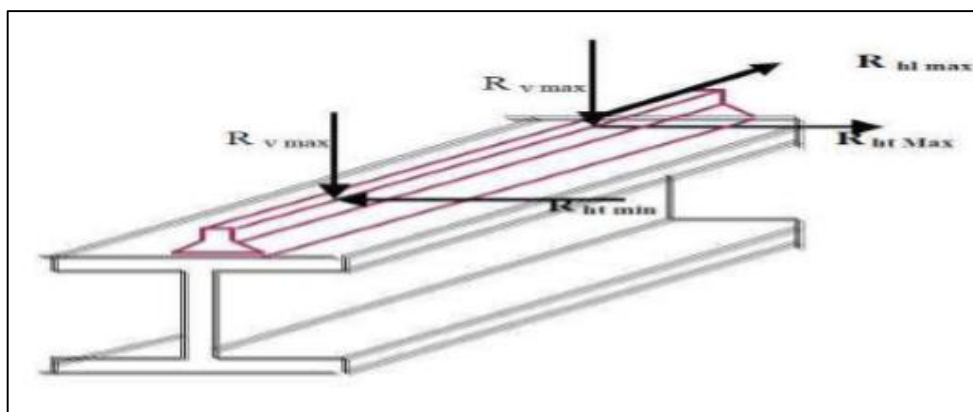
Schéma de la poutre de roulement avec le rail.
